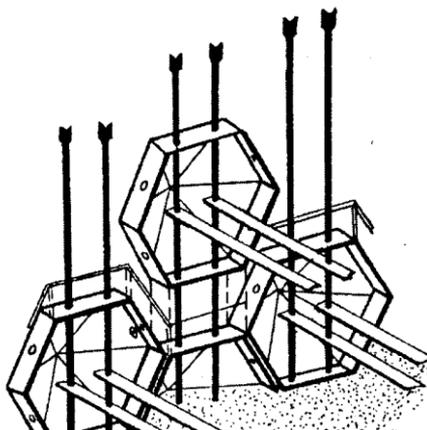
Конструкция, применяемая для армирования грунта по методу Йорка
